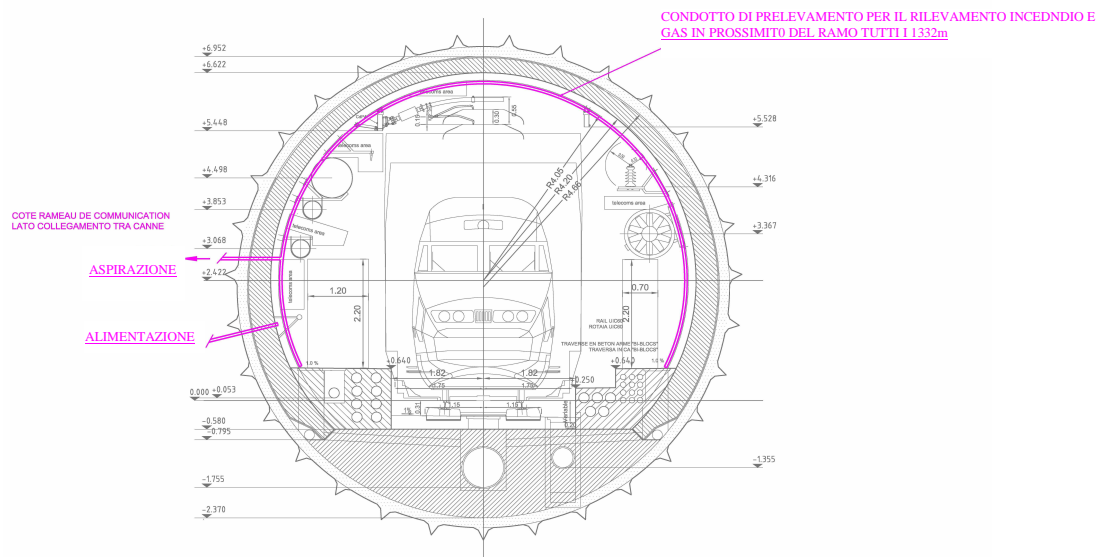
Spaccato tipo in tunnel per il sistema di prelievo
